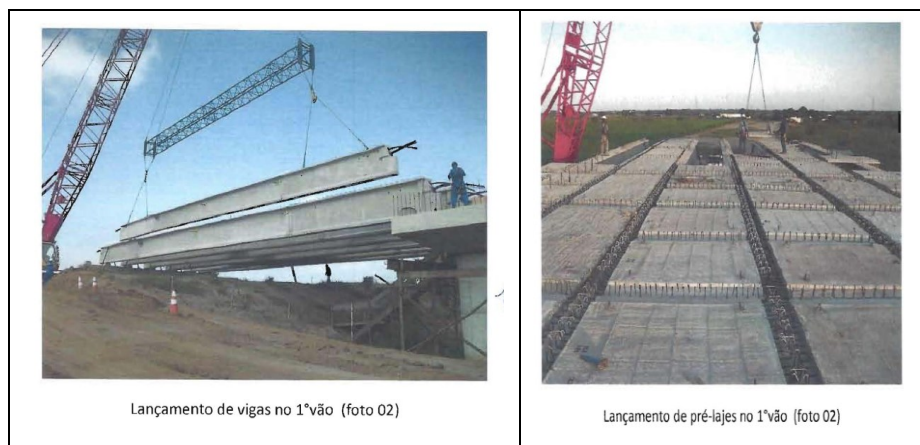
Lançamento de vigas e pré-lajes com guindaste
